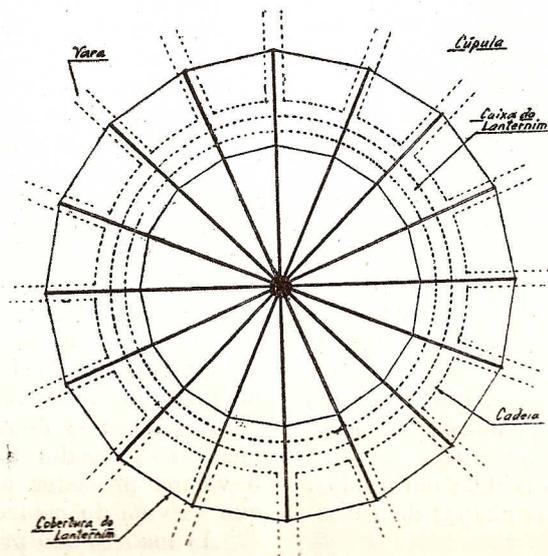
PLANTA DA COBERTURA DO LANTERNIM
